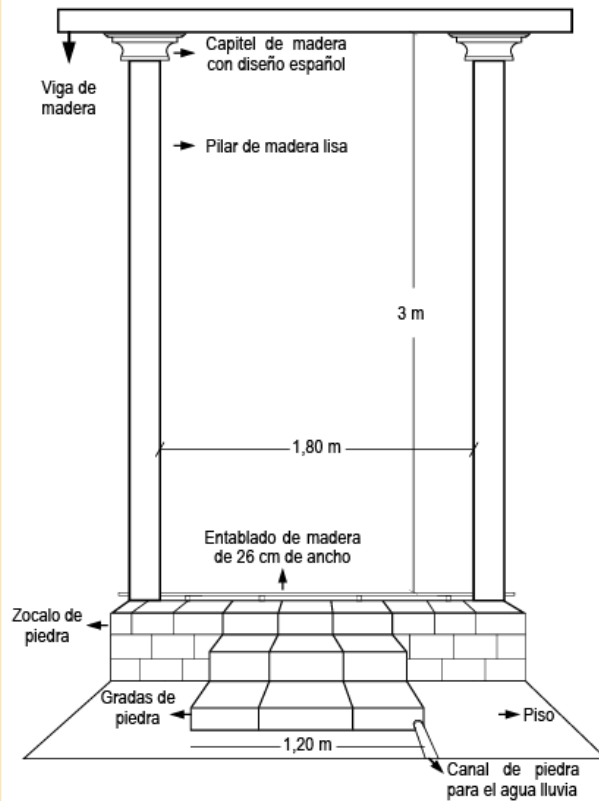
En la ilustración se observa un pórtico con un acceso de gradas en piedra de "tres niveles" muy típico de la época de construcción salvando una altura aproximada de 60 cm con un ancho de 120 cm y terminando el acceso con dos pilares de madera con fuste liso y capitel moldeado, ambos elementos estructurales que soportan una viga de madera donde descansa la estructura de la cubierta. Al inicio de las gradas de piedra se observa un canal para el agua lluvia que sirve para desembocar el líquido hacia el patio y no afectar la integridad de la madera con la humedad y la misma agua.
